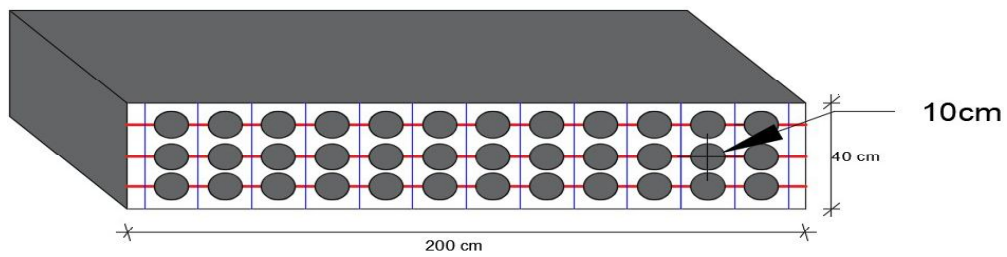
Betonarme bloğun A-A kesitindeki donatı şeması.
